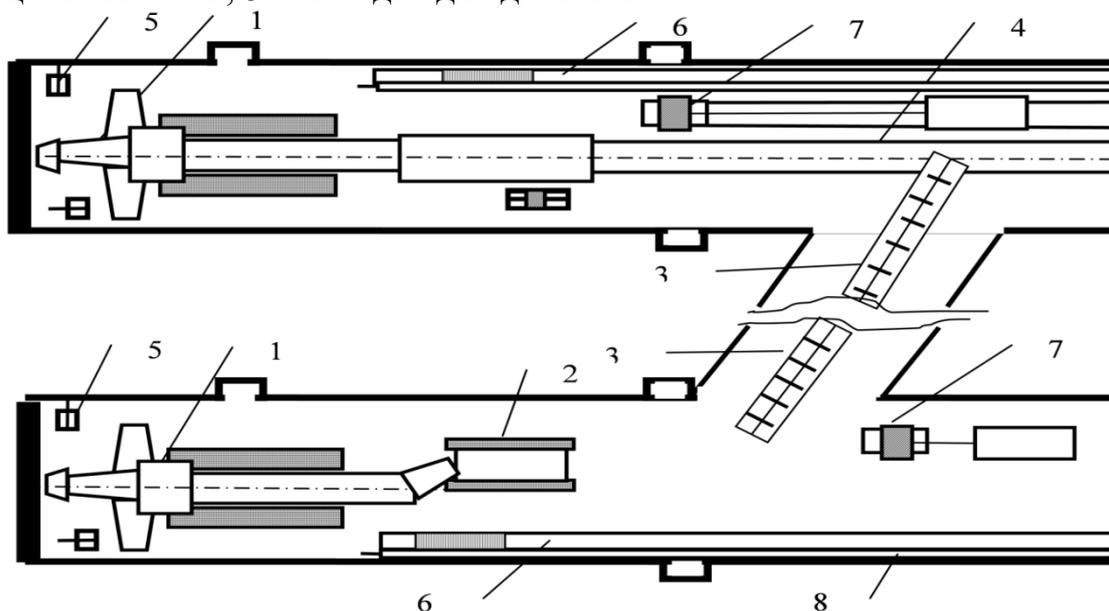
Технологическая схема 3 (вид сверху): 1 – проходческий комбайн; 2 – самоходный вагон; 3 – скребковый конвейер; 4 – ленточный конвейер; 5 – ручные бурильные установки; 6 – вентиляционный став; 7 – лебедка для доставки; 8 – противопожарный став
